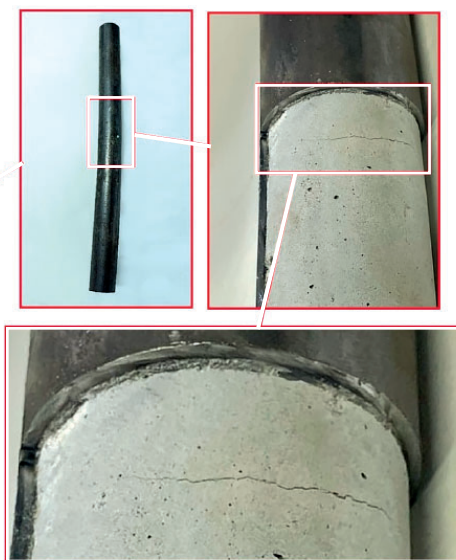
Разрушение трубобетонной балки по нормальному сечению
